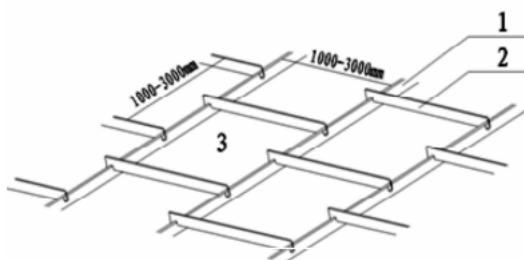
坡屋面种植设计基本构造层次挡板示意图
